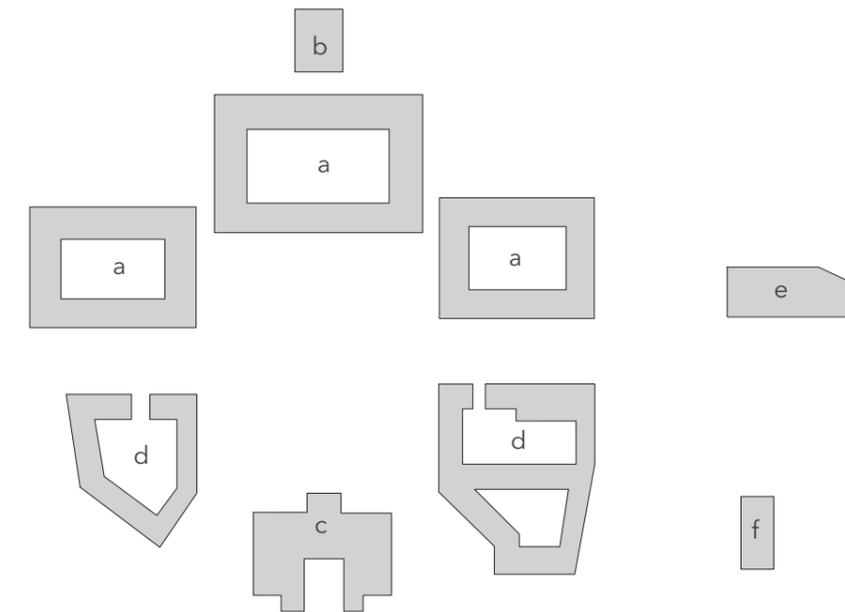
schematischer Grundriss eines Familistère von Godin
